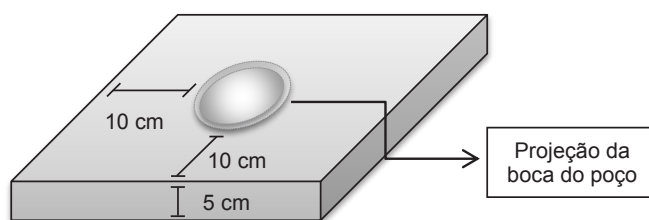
Desenho esquemático da laje de proteção sanitária do poço.
